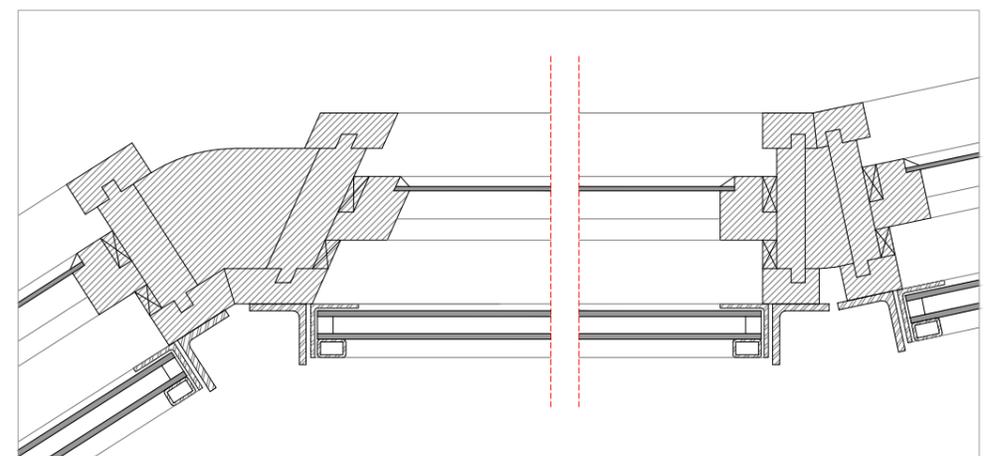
Planta de Nova Caixilharia da Parede-cortina | Escala 1:5
